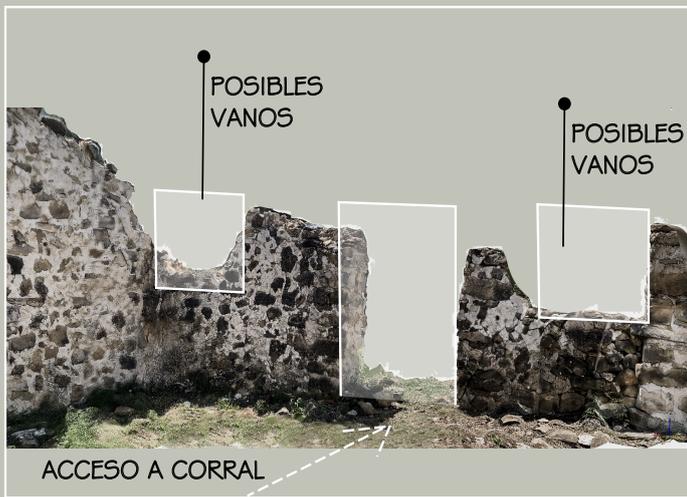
, 52 y 53: Esquemas y plano en planta del sitio. Fuente: Elaboración propia
